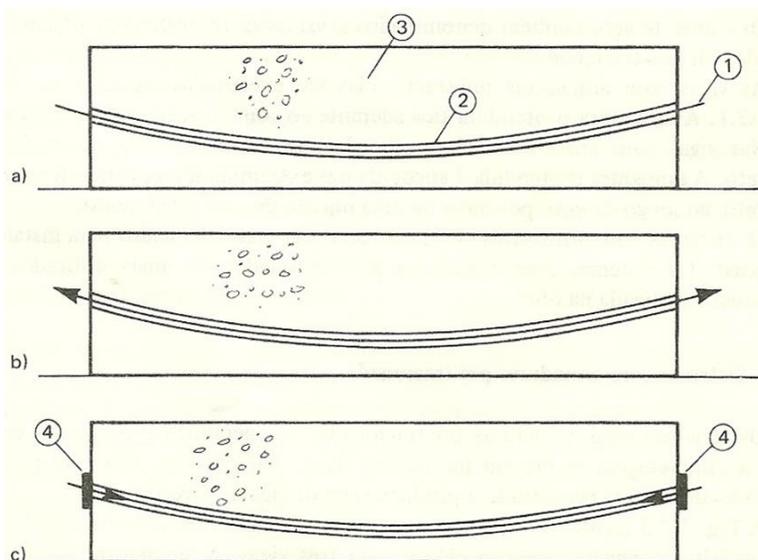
Sequência construtiva de vigas com armaduras pré-tracionadas.
